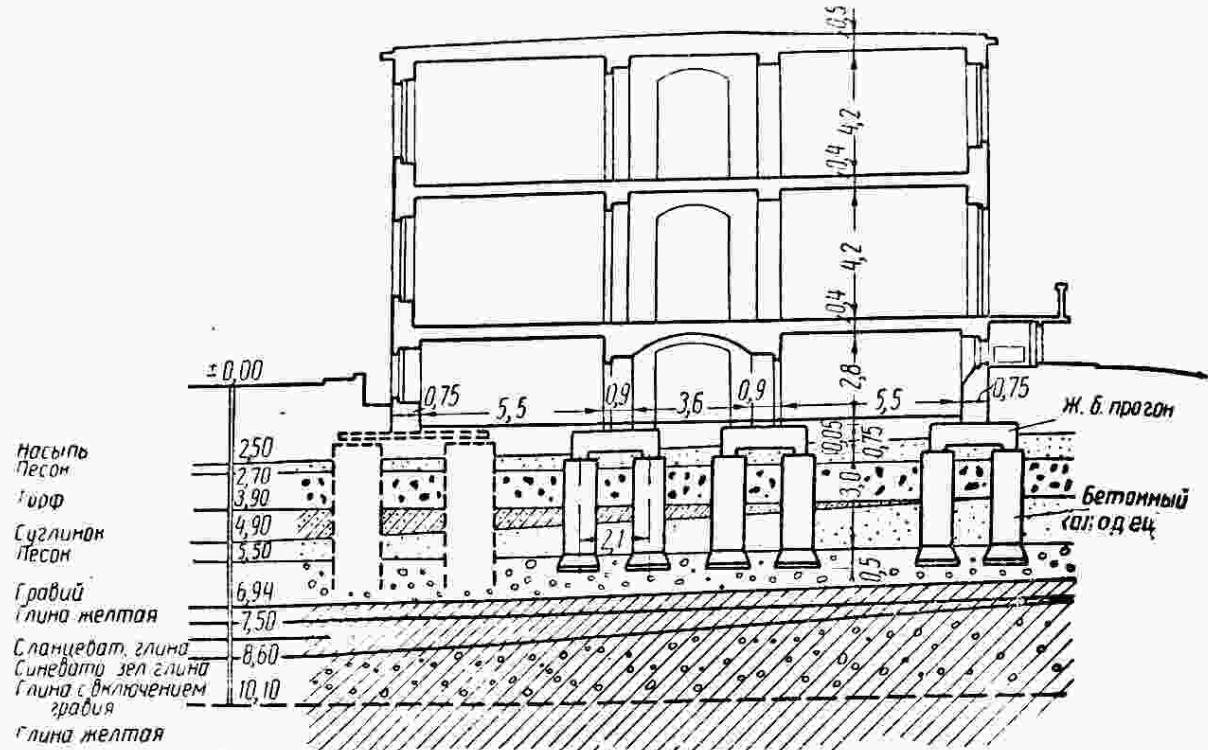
Разрез фундаментов и здания клиники на ул. Балаша
